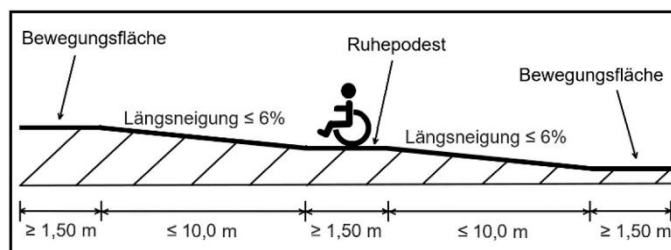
Schematischer Aufbau einer Steigung mit Ruhepodest nach jeweils 10 m Länge
